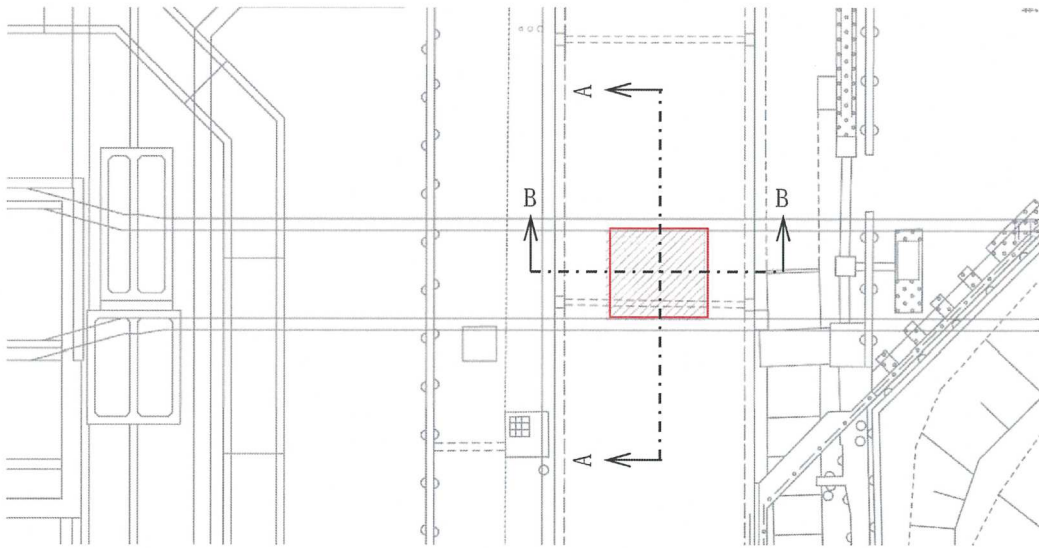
(1) 取放水路流路縮小工（第1号機放水路） 平面図
